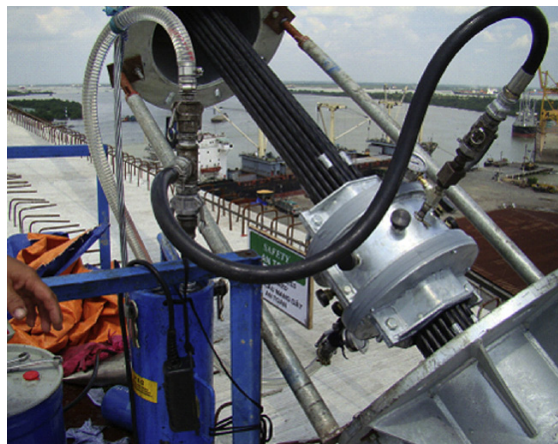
Montaje de amortiguador en el Puente de la Constitución de 1812. (Sanchez, Trotin, & Ladret, 2016)
